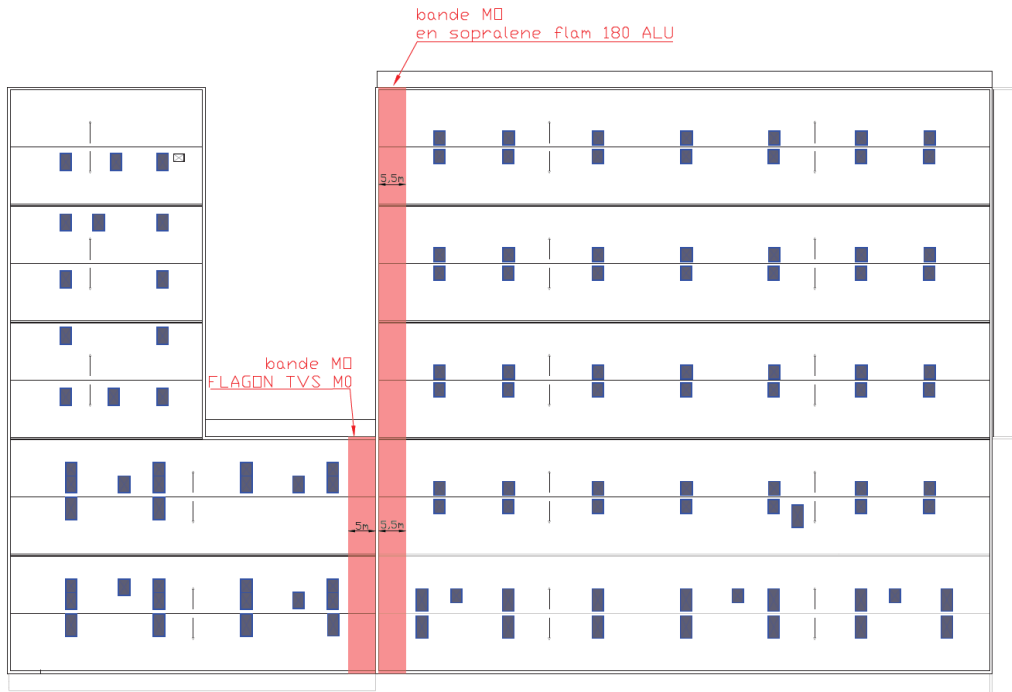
Plan de repérage des bandes de protection en toiture (source : TARKETT)
